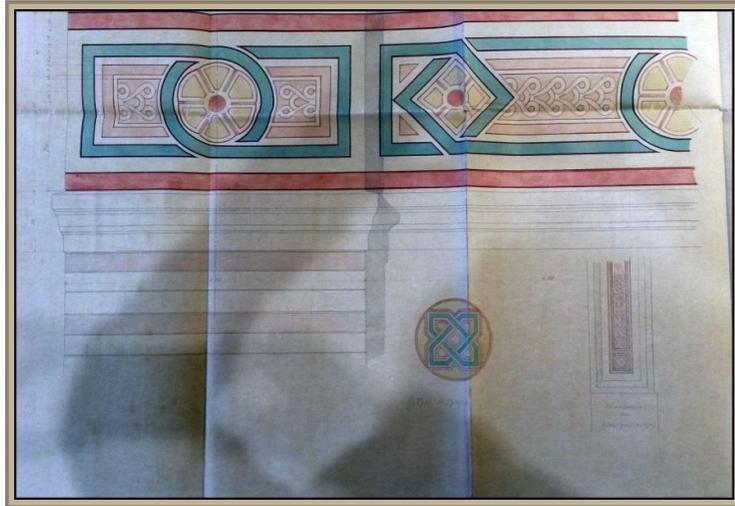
Service de la construction, Frise des pavillons de tête plans d'exécution, 1877
